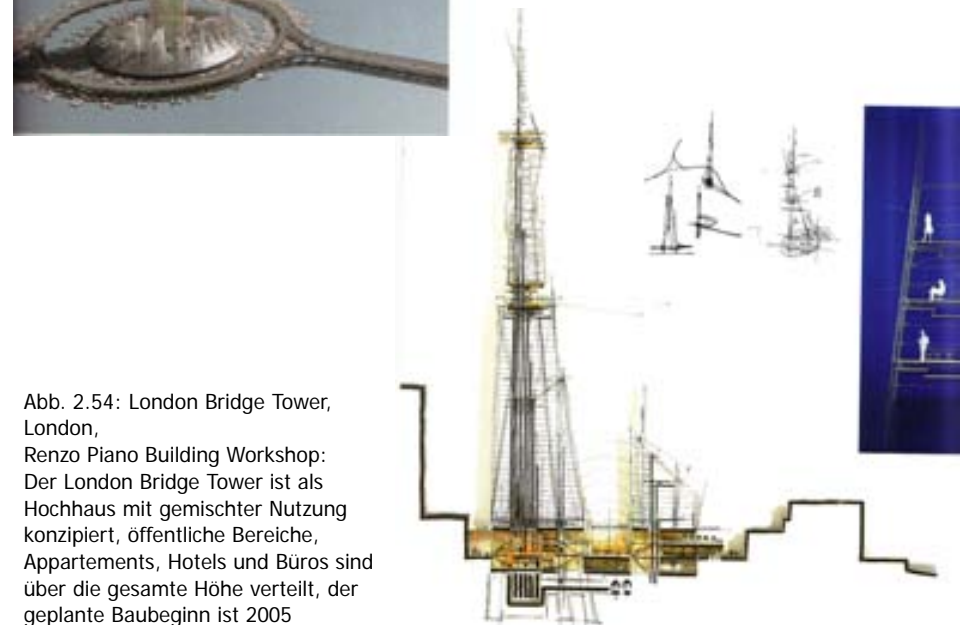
London Bridge Tower, London, Renzo Piano Building Workshop: Der London Bridge Tower ist als Hochhaus mit gemischter Nutzung konzipiert, öffentliche Bereiche, Appartements, Hotels und Büros sind über die gesamte Höhe verteilt, der geplante Baubeginn ist 2005
